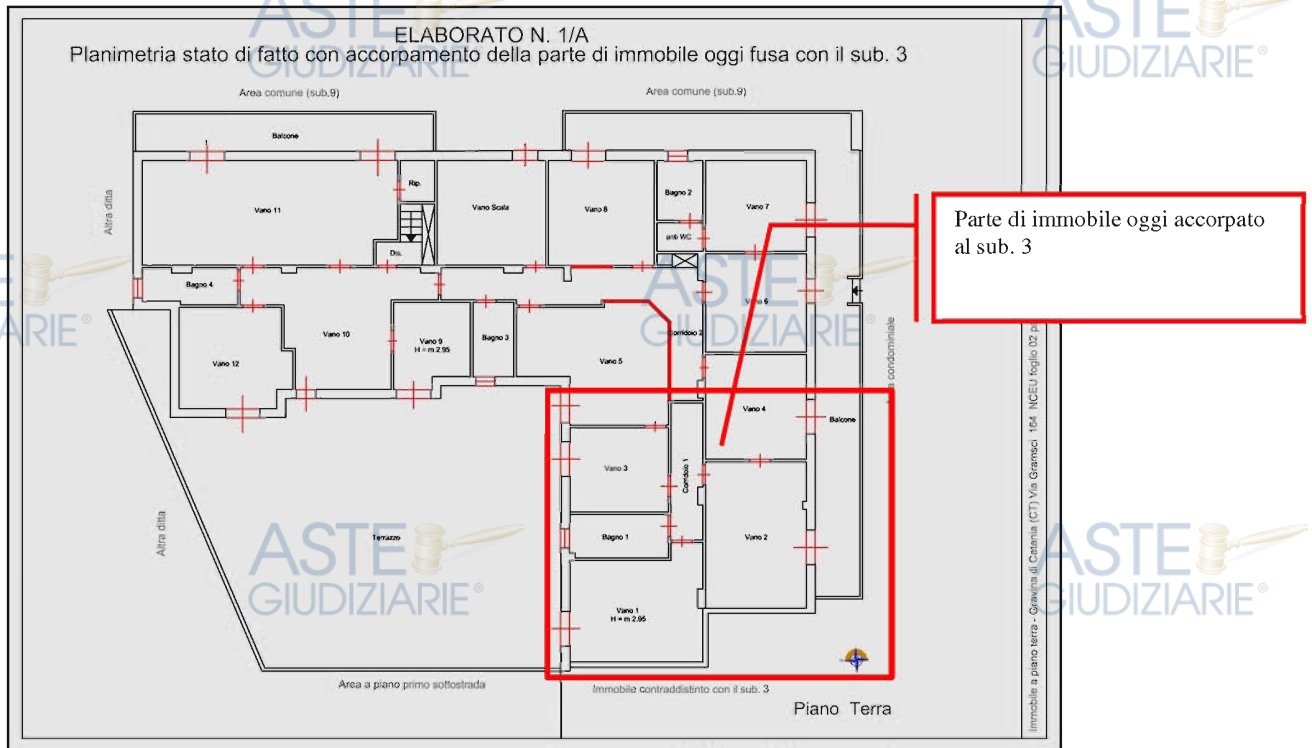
Visualizzazione della planimetria attuale del piano terra dell'immobile contraddistinto con il sub. 10. Tale planimetria riporta l'intero immobile e cioè ingloba anche la parte oggi accorpata al sub. 3.
